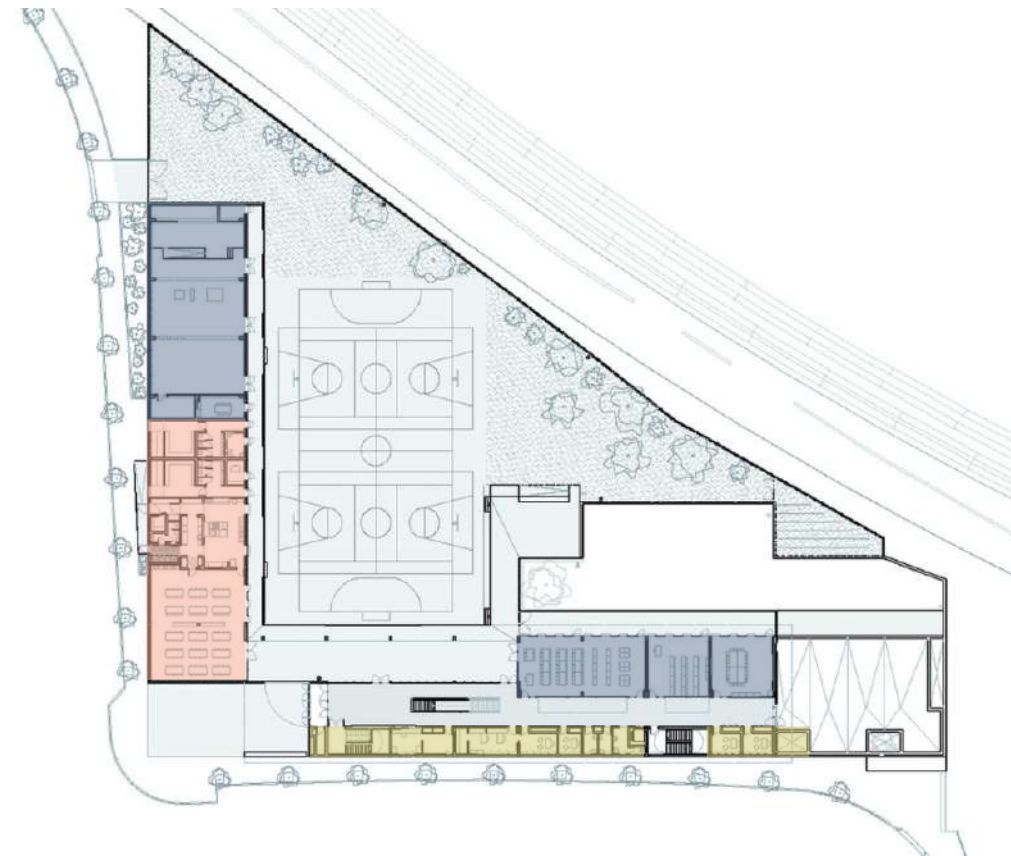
Planta baixa térreo - Fonte: Archdaily, 2014
